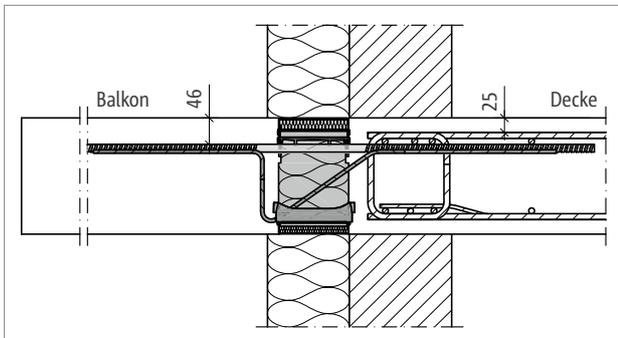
Schöck Isokorb® CXT Typ K-CV46: Anschluss bei deckengleichem Unterzug
